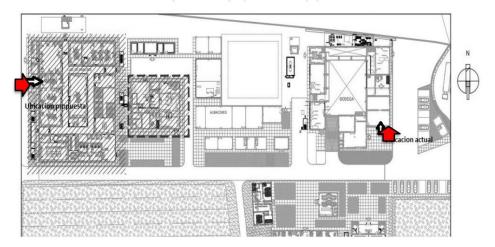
Ubicación contemplada en el PIP y ubicación propuesta para el traslado.
